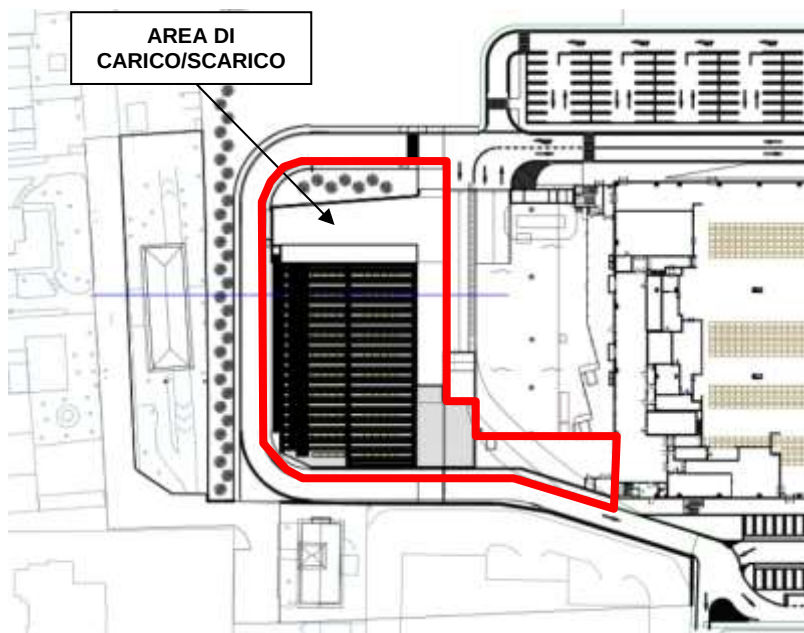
Planimetria (area di intervento evidenziata con riquadro rosso)
